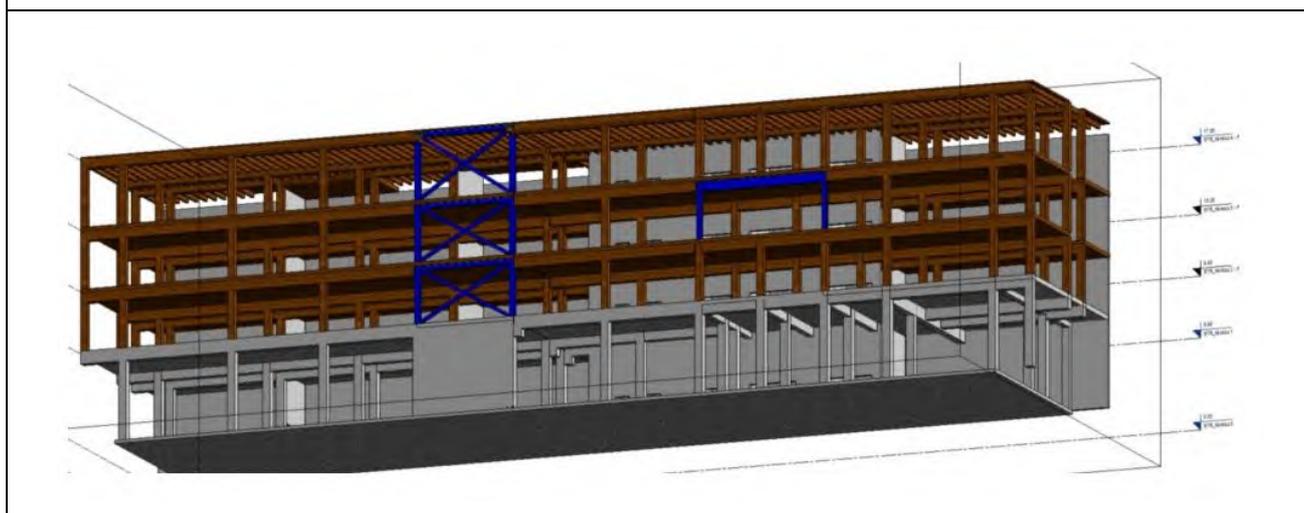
Extrait du plan 3D du bâtiment du projet,
